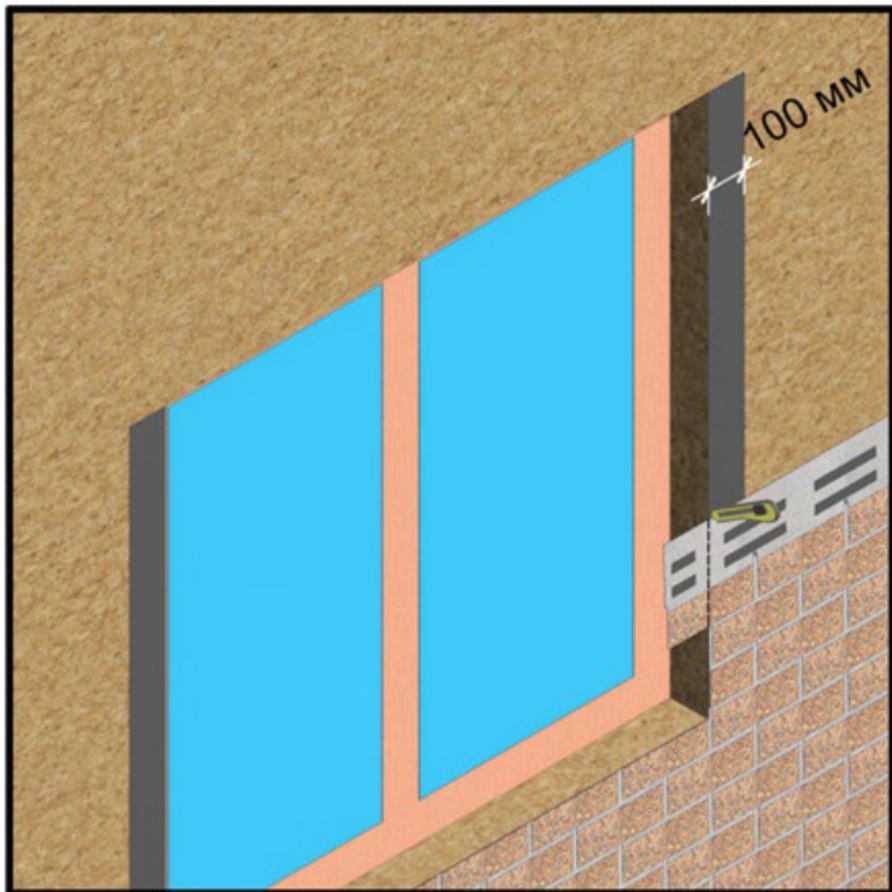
Подрезка фасадной плитки при подходе к углам оконных проёмов.
